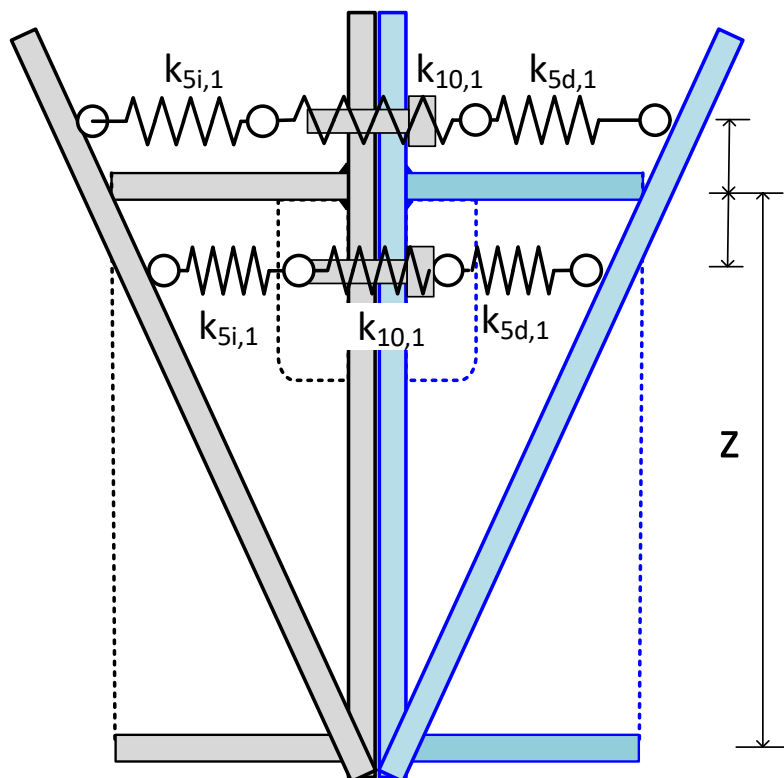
Modelo simplificado para unión viga – viga con dos filas de tornillos
